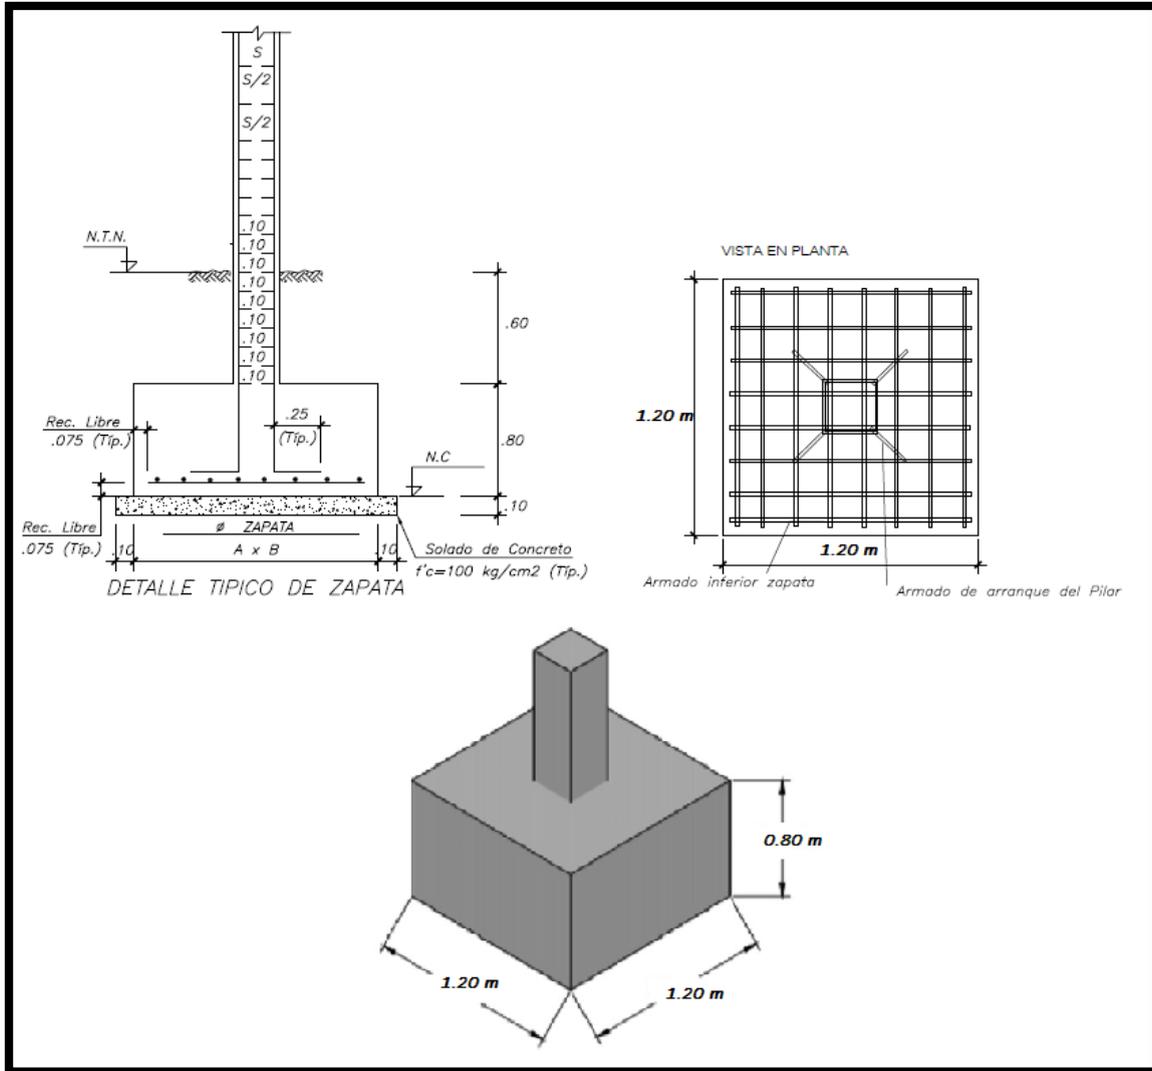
Dimensiones de la zapata cuadrada elegida para el diseño de cimentación para un sistema de pórticos en vista planta, corte y 3D.
